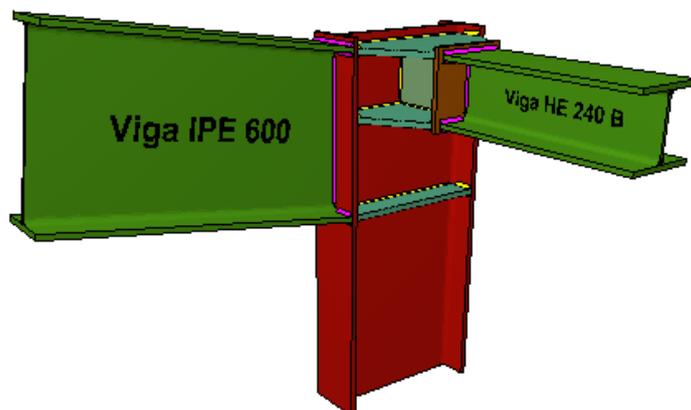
Soldadura S7. Fuente: CYPE 2017
